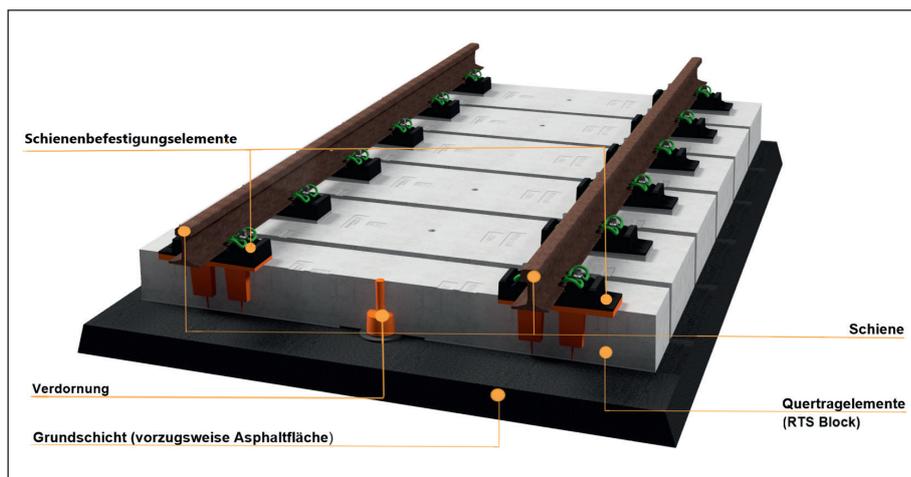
Aufbau der FF Bauart IVES mit dem Schienenstützpunkt DFF 304
